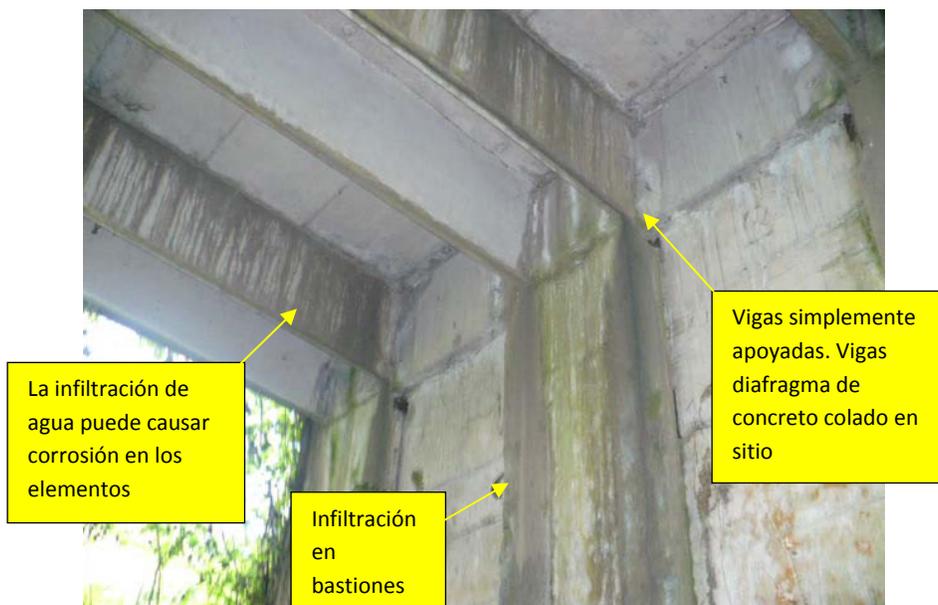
Vista mostrando apoyo simple de vigas principales e infiltración de agua.
